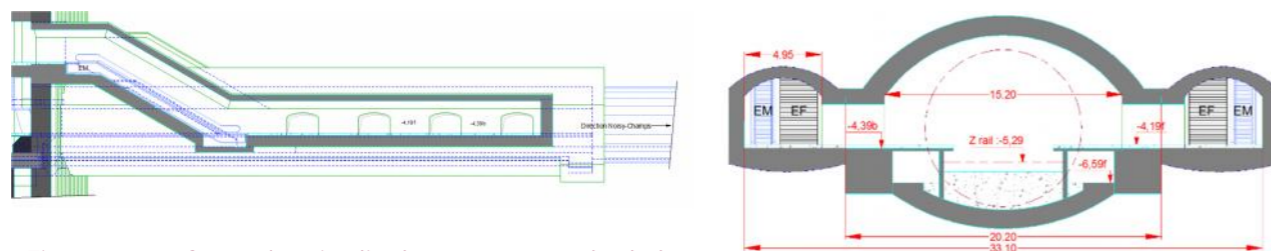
Coupe longitudinale et transversale de la zone souterraine
